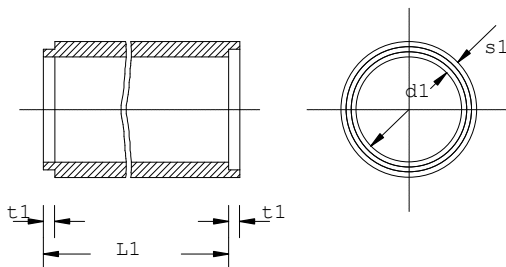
tubi in calcestruzzo di sezione circolare con giunto a risega senza piede
